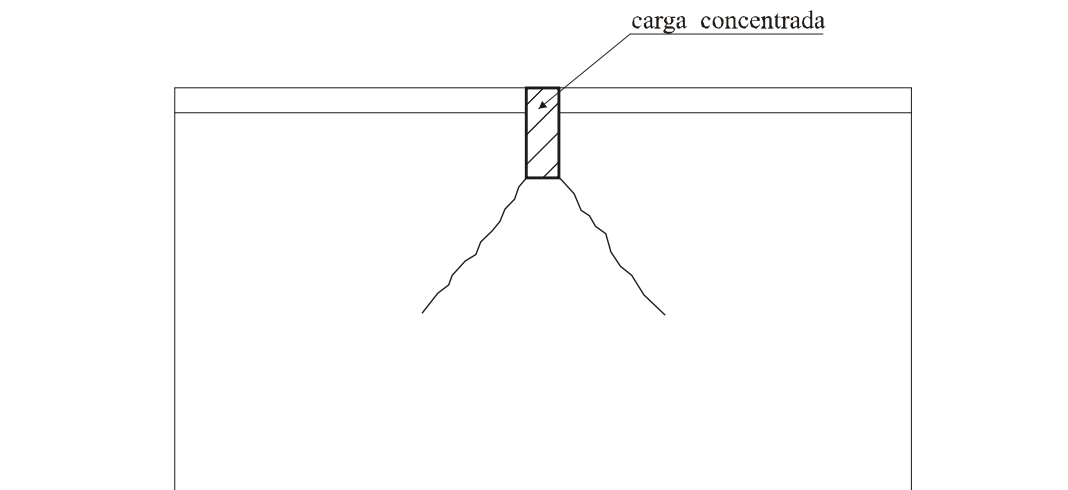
Fissuras inclinadas provocadas pela ação de cargas concentradas diretamente sobre a alvenaria
